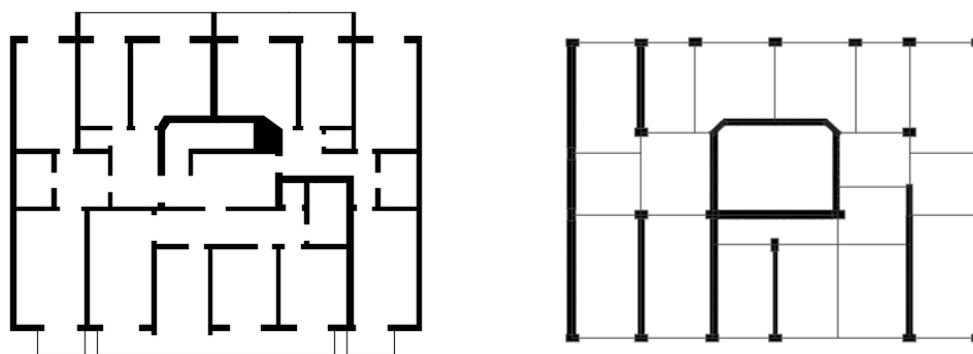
Traçado da planta em AutoCAD do edifício tipo (à esquerda) e identificação das paredes de alvenaria que foram modeladas (à direita)
